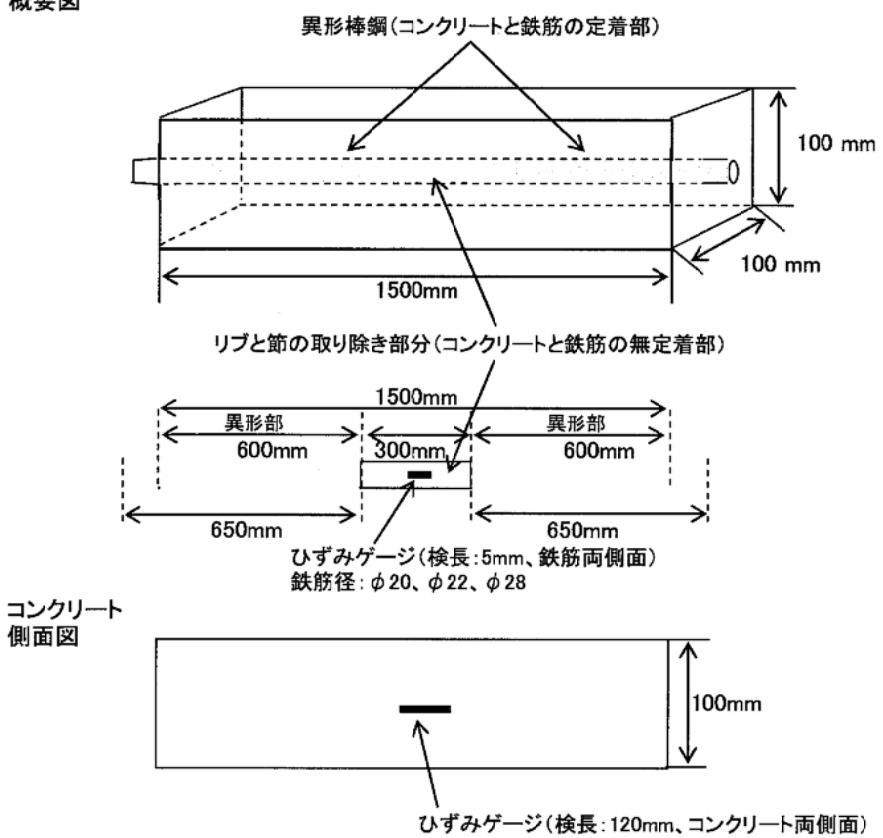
ひび割れ抵抗性試験供試体の概要
